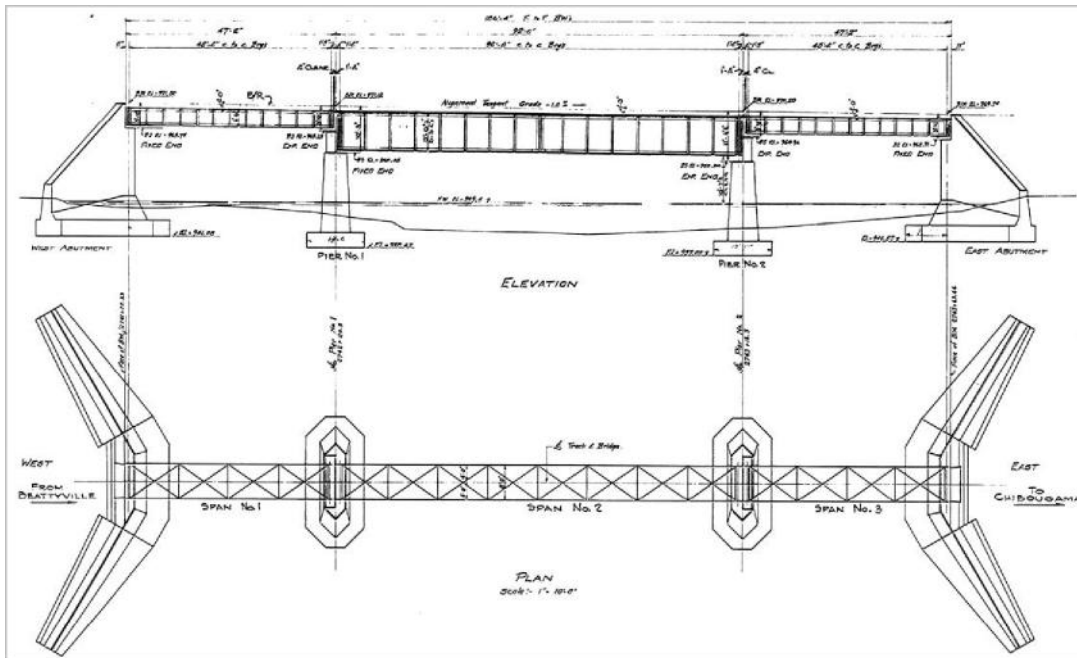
Plans et vues en élévation du pont PM 91.00 Chapais
